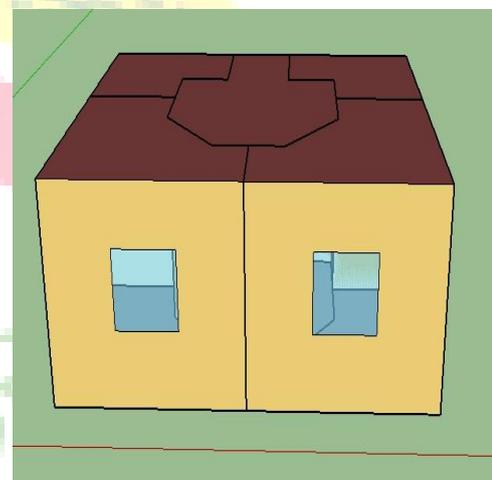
Disposition des Vitrages sur la façade Sud du Studio
